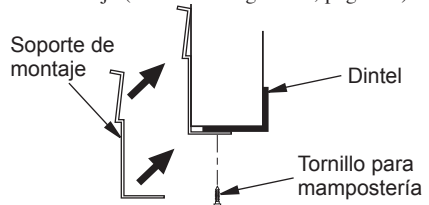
Ubicación de los soportes para chimenea de mampostería sin puertas de vidrio
